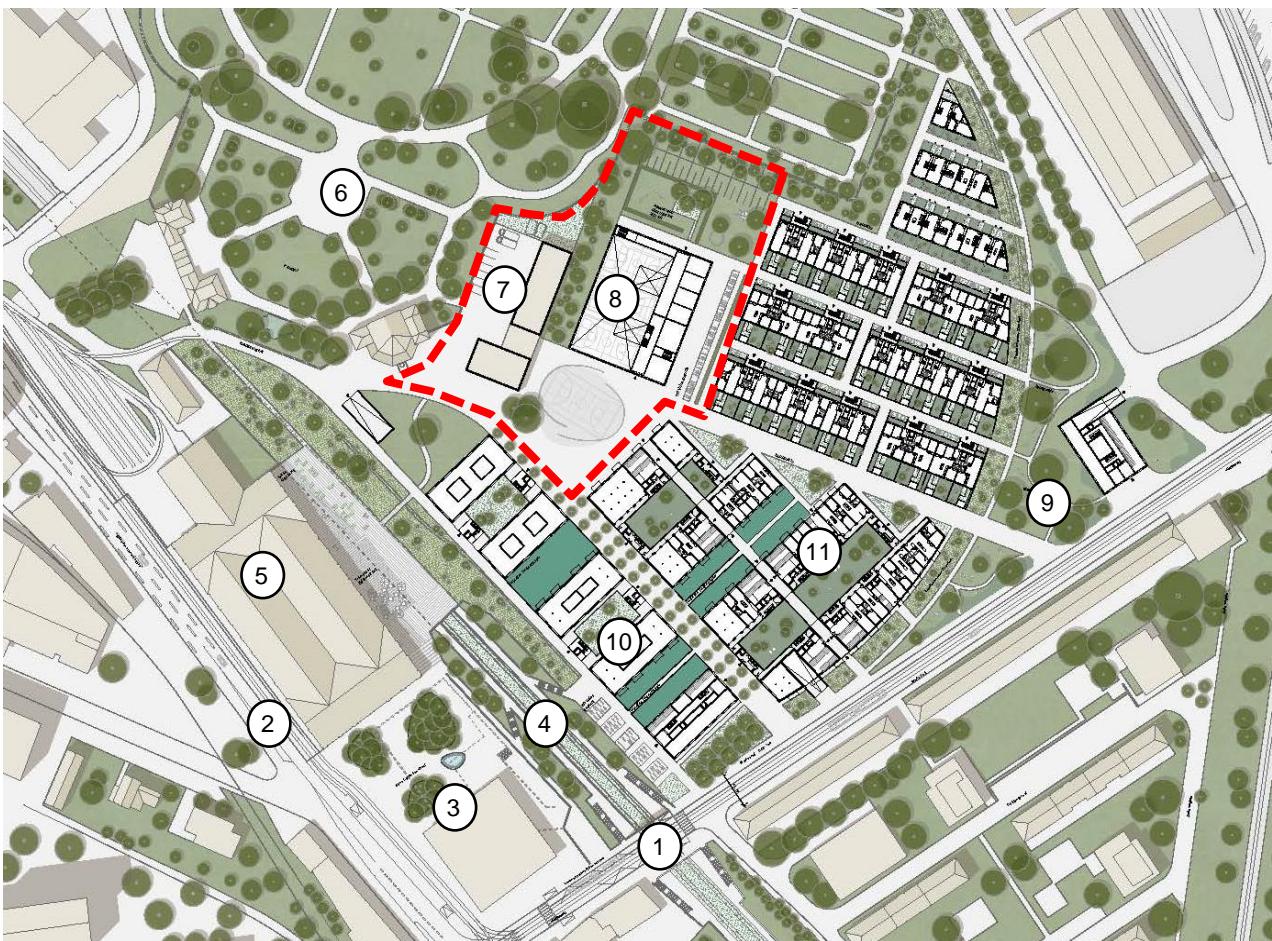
Bebauungsvorschlag des Planungsteams um die Camponovo Baumgartner Architekten. 1 Walkeweg; 2 Münchensteinerstrasse; 3 Irene Zurkinden-Platz; 4 S-Bahnstation Dreispitz; 5 Tramdepot; 6 Wolfgottssacker; 7 Werkhof Stadtgärtnerei; 8 neue Primarschule; 9 Arealteil SBB; 10 Standort bestehende temporäre Wohnbauten (im Plan nicht mehr dargestellt); 11 erste Bauetappe (Plan genordnet).
